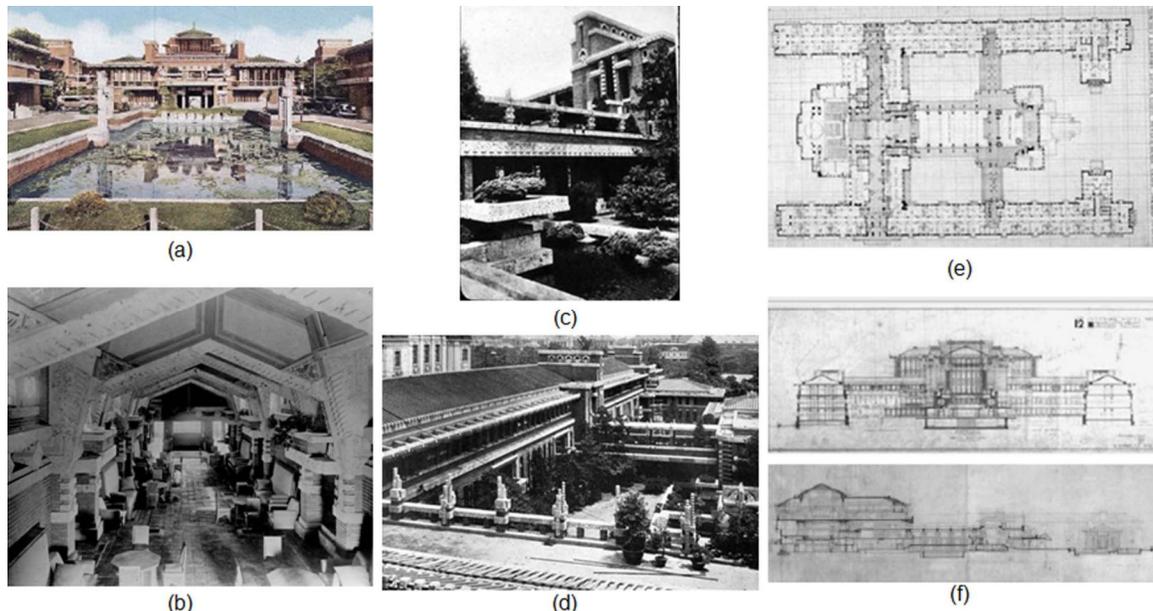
Frank Lloyd Wright, Hotel Imperial en Tokio, Japón, (1916, demolido en 1968): (a) Vista exterior general, (b) Detalle interior – vestíbulo, (c) Detalle exterior, (d) Vista aérea, (e) Planta arquitectónica, (f) Secciones transversal y longitudinal.
